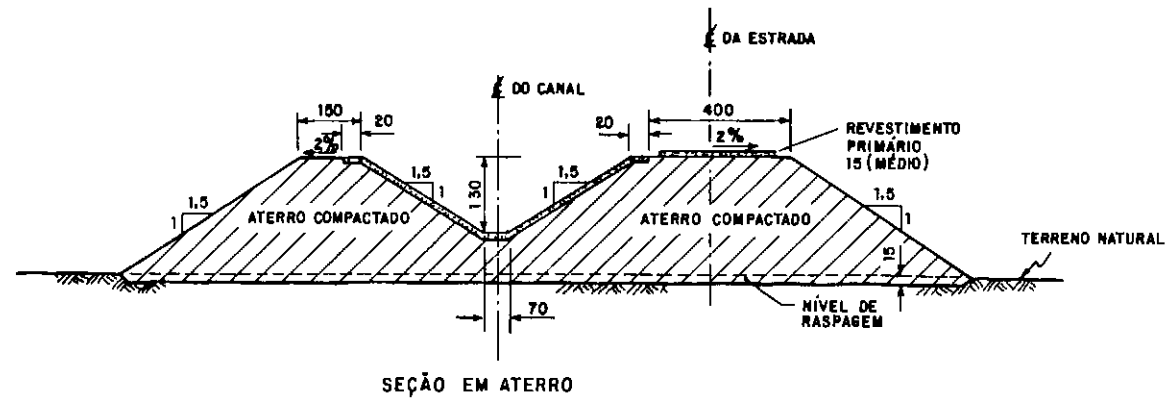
Seção transversal típica B (Apud CEPED, 1988)
